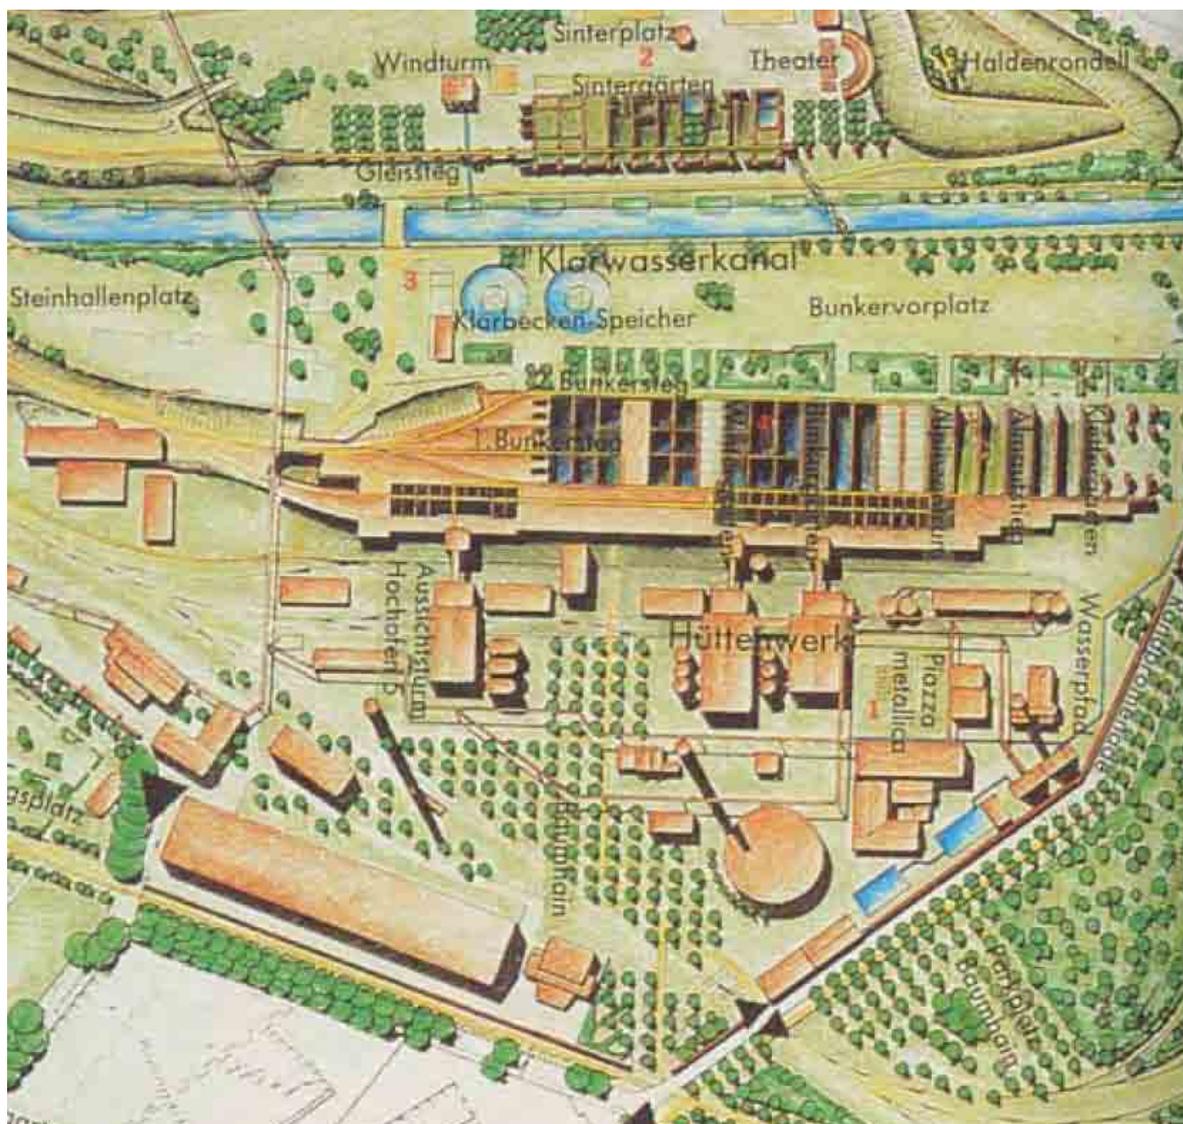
1: Planimetria dell'intervento sugli edifici
